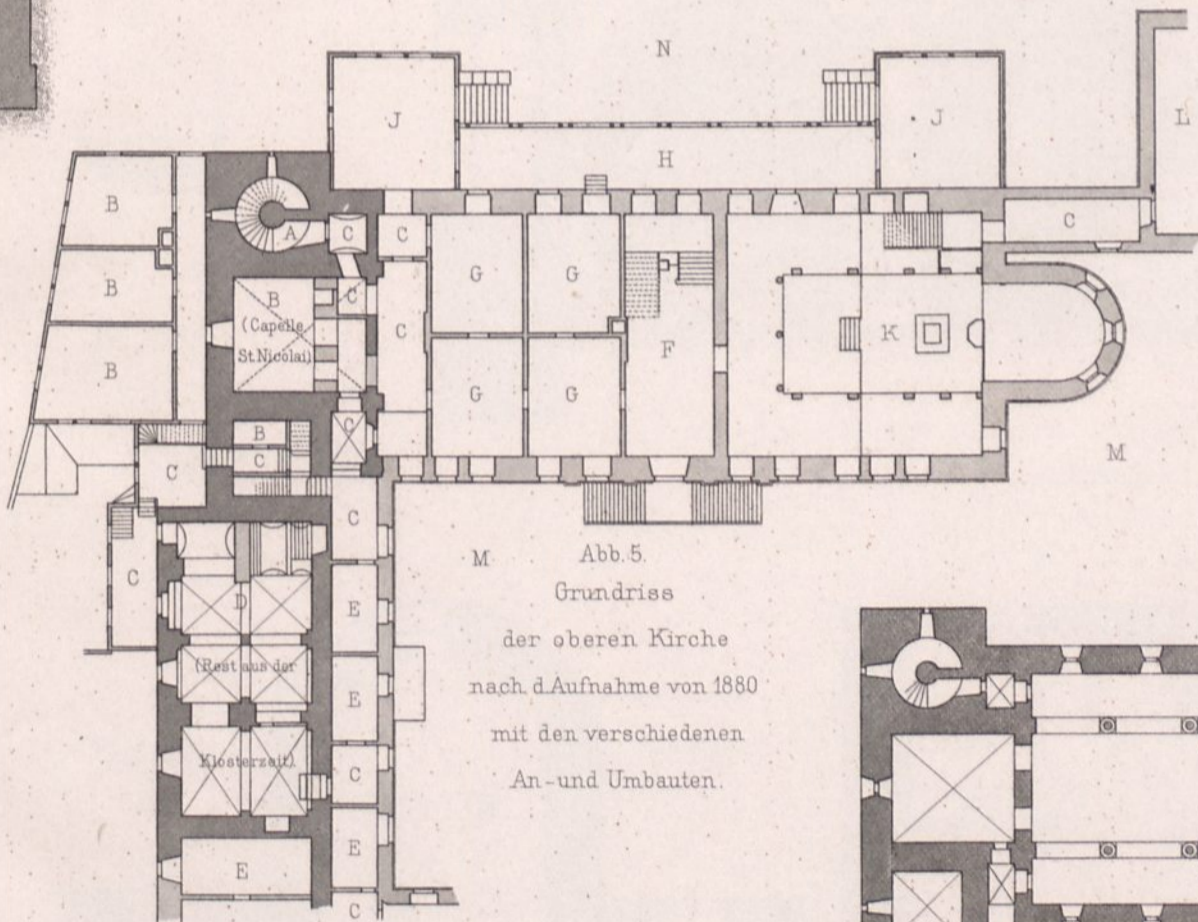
Grundriss der oberen Kirche nach d. Aufnahme von 1880 mit den verschiedenen An- und Umbauten.
